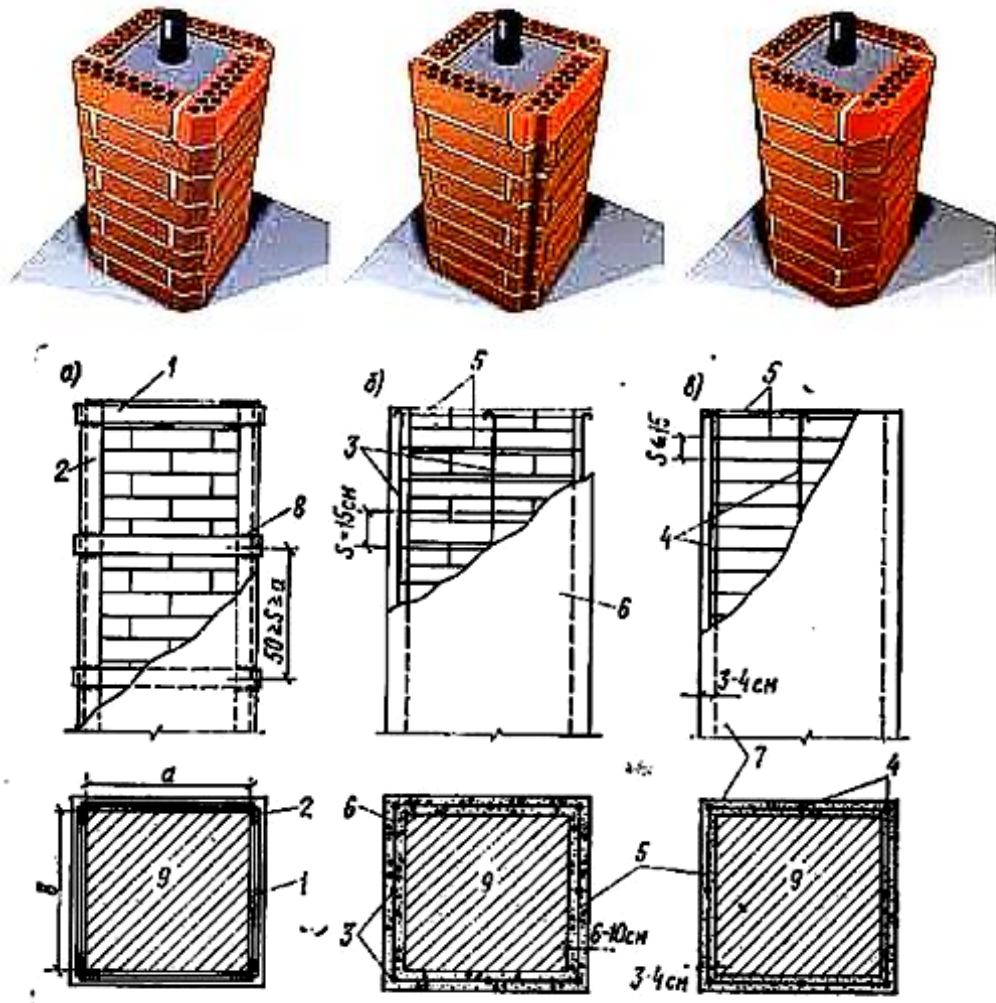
Схема посилення пошкоджених простінків і стовпів обоймами: а - сталевую; б - залізобетонною; в - армованою розчинною; 1 - планки 35x5-60x12 мм; 2 - кутники; 3 - стрижні діаметром 5-12 мм; 4 - стрижні діаметром 6-12 мм; 5 - хомути діаметром 4-10 мм; 6 - бетон марки М 150-200; 7 - розчин марки 75-100; 8 - зварка; 9 - кладка
